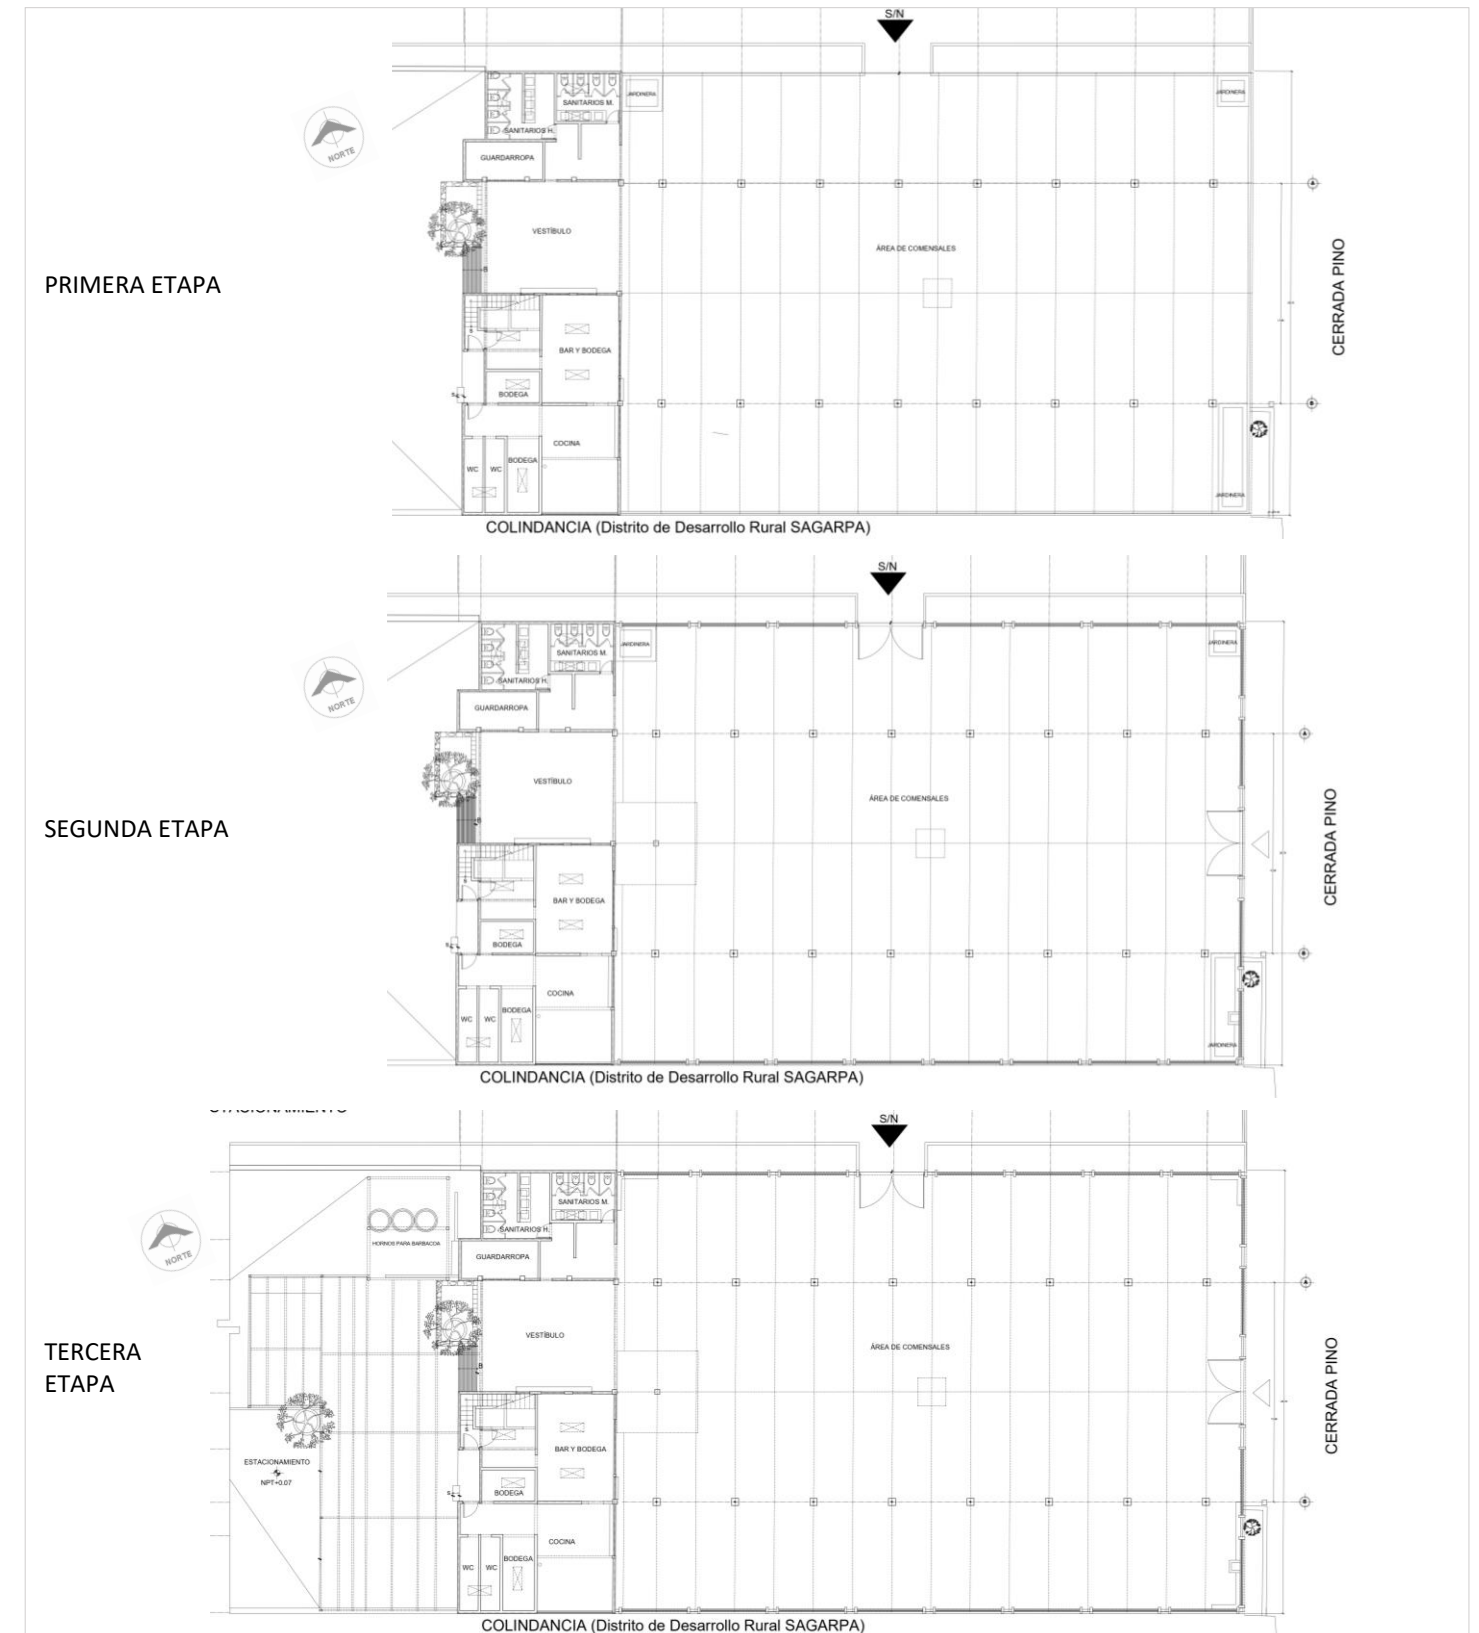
Etapas de construcción del Restaurante Las Flores (Elaboración propia).
